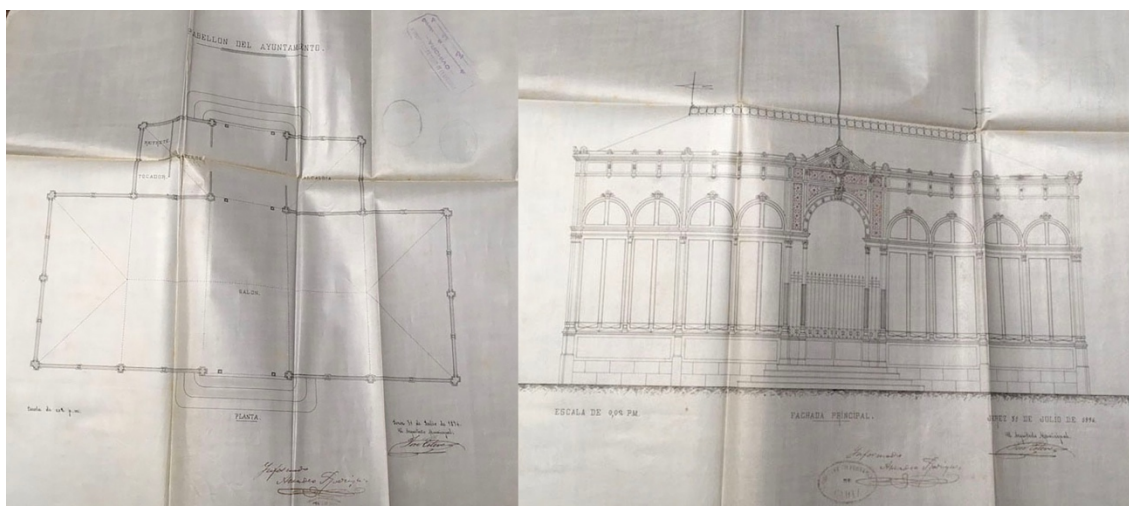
Planta y alzado del proyecto para el pabellón del Ayuntamiento de José Esteve (1896). Fuente: AMJF.
